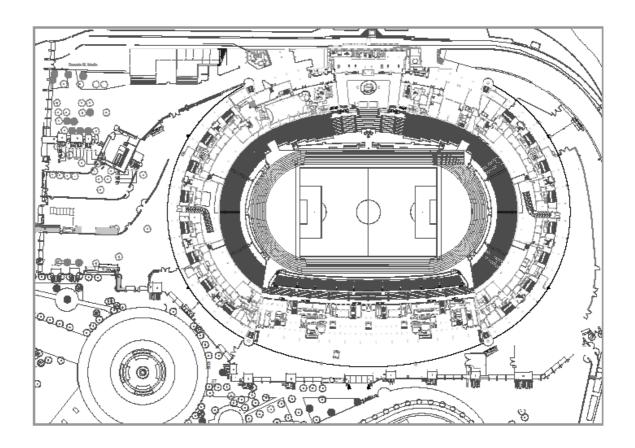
Planimetria Piano Terra Stadio Olimpico
